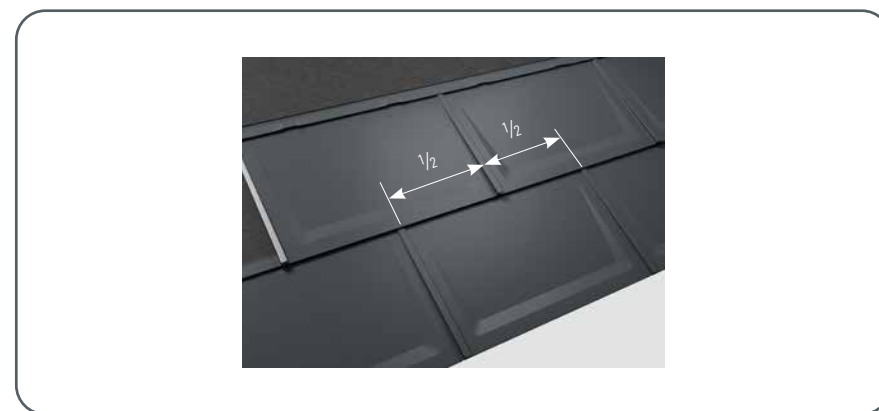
• Rozmer šnúrovania pre strešný panel R.16
